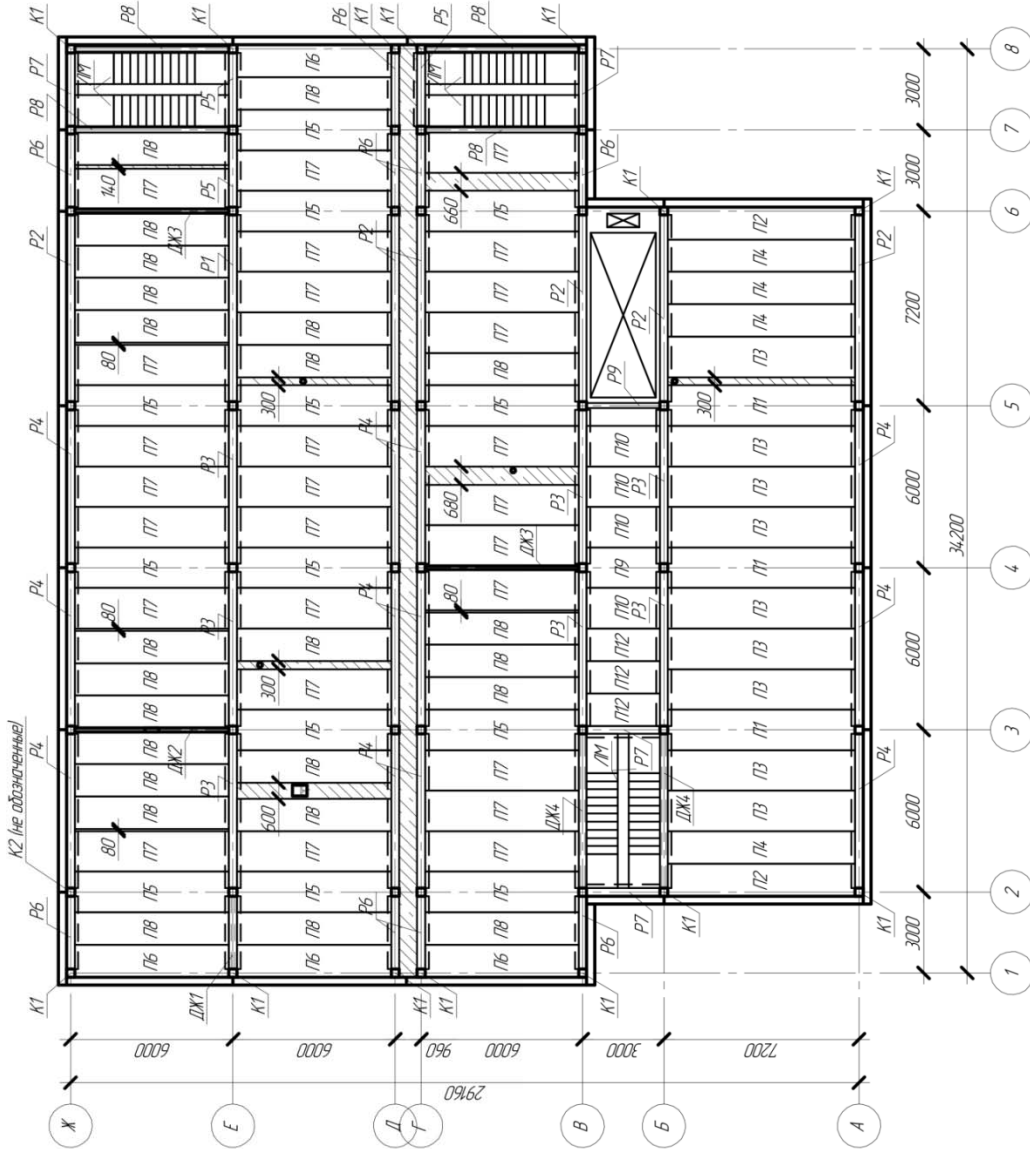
Пример выполнения схемы расположения элементов перекрытия
